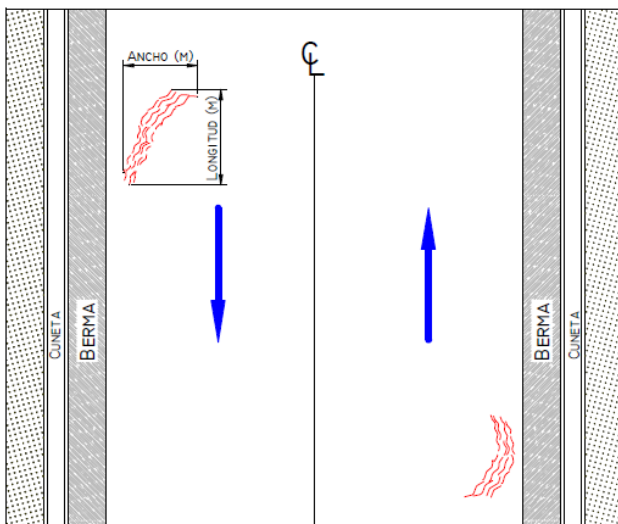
Exudación sobre pavimento asfáltico existente.
